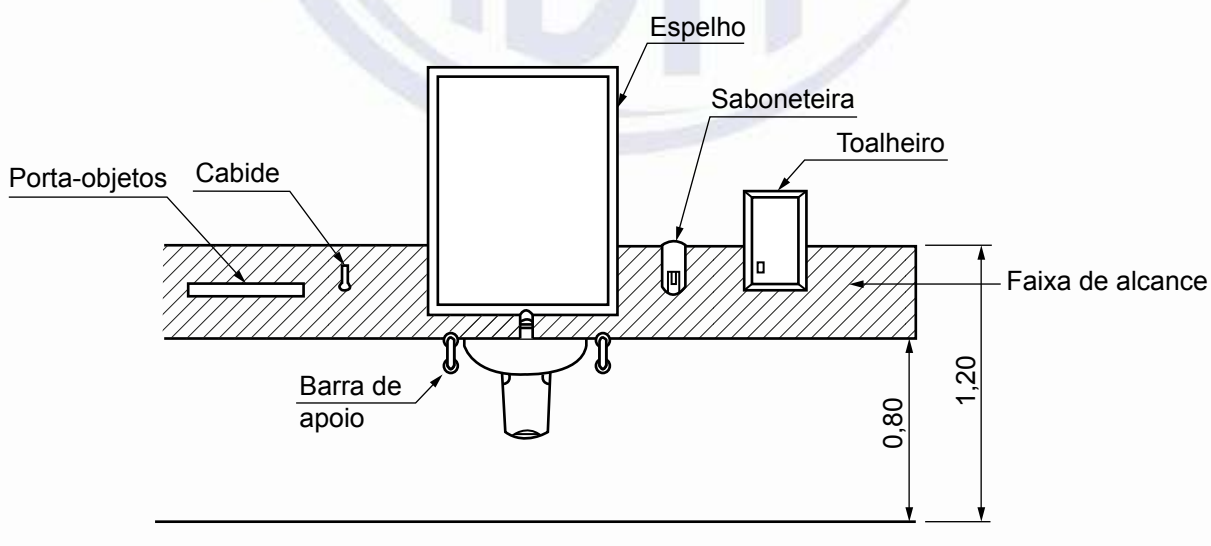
Faixa de alcance de acessórios junto ao lavatório – Vista frontal
